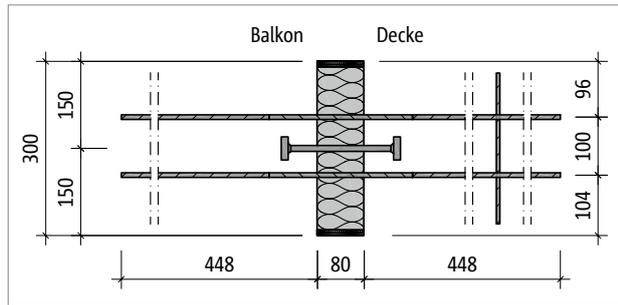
Schöck Isokorb® T Typ Q-P-V1: Produktgrundriss
